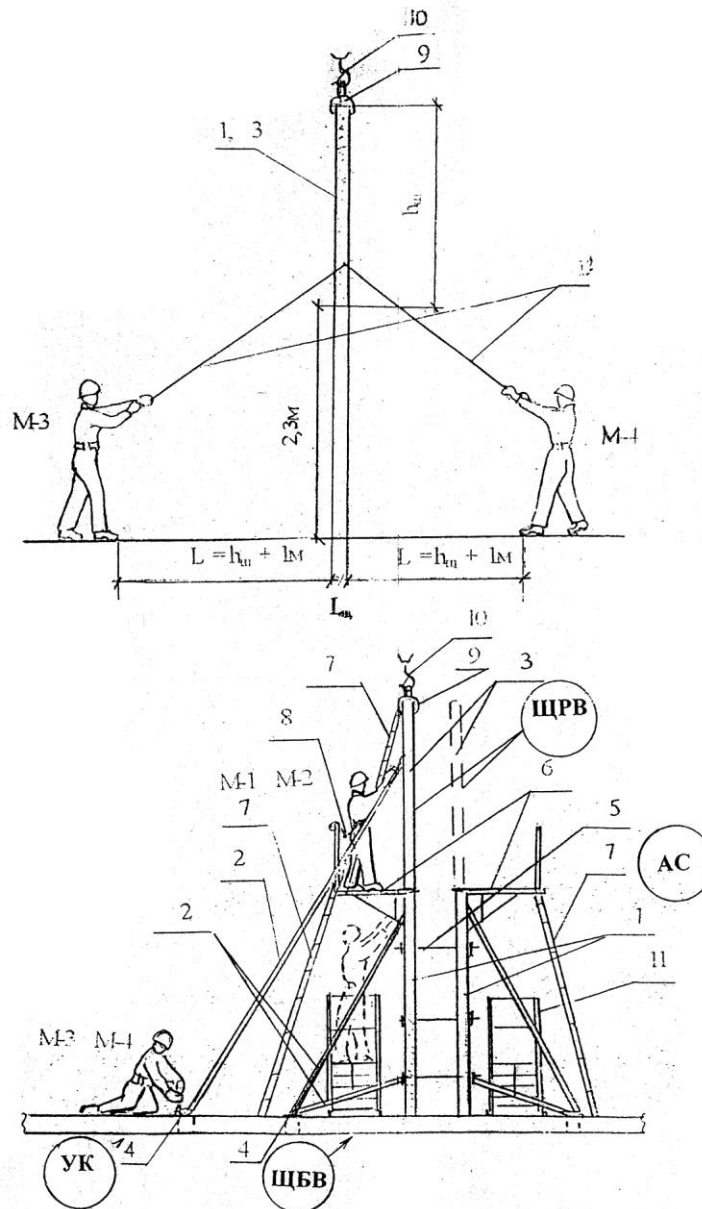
Схема транспортування і монтажу вертикальних щитів опалубки:
